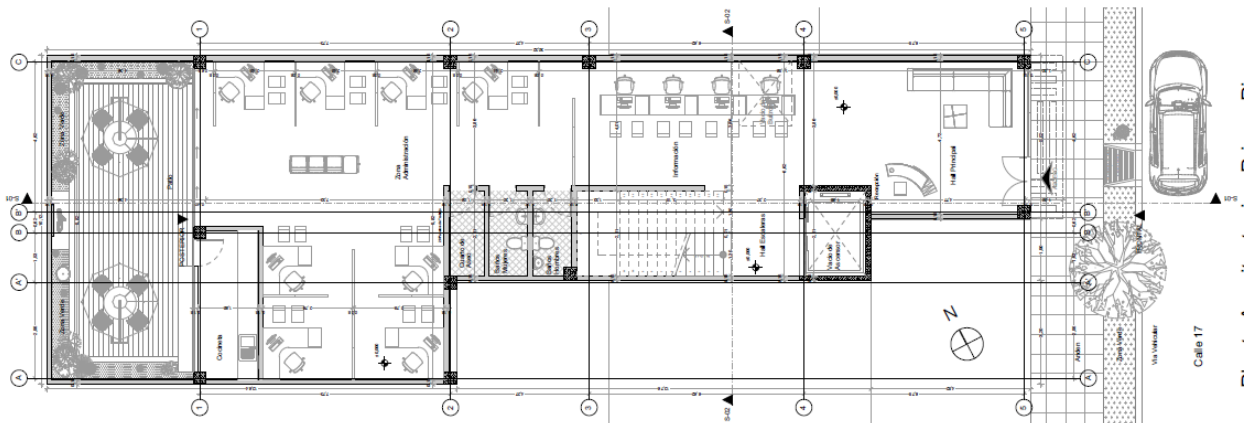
Planta Arquitectónica 1 Primer Piso Actual Cafaba.
